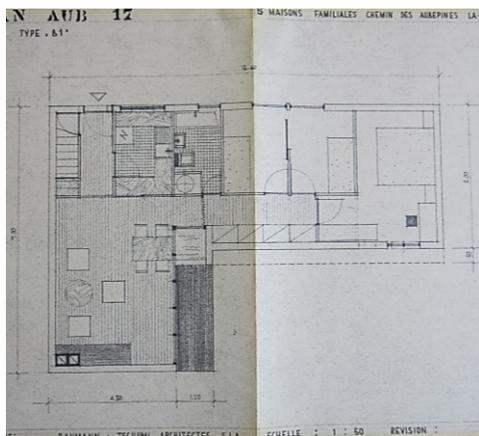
Grundriss eines der Häuser, Plan vom 30.04.1956
